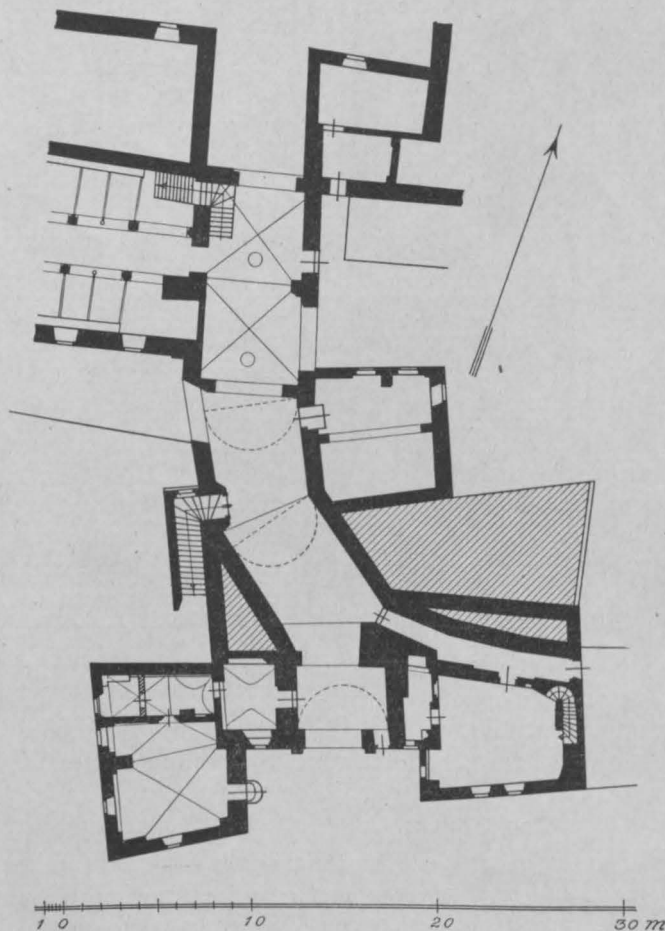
Sonnewalde. Grundriß des Vordereschlosses.
